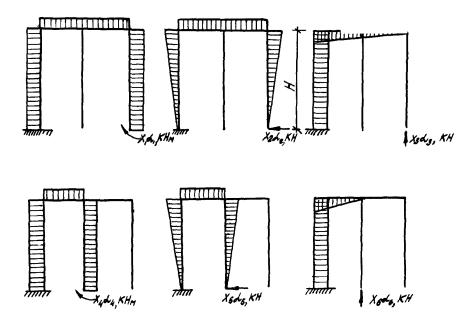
Эпири для перераспределения усилий в рамных конструкциях подпорных стен из буронабивных свай.
